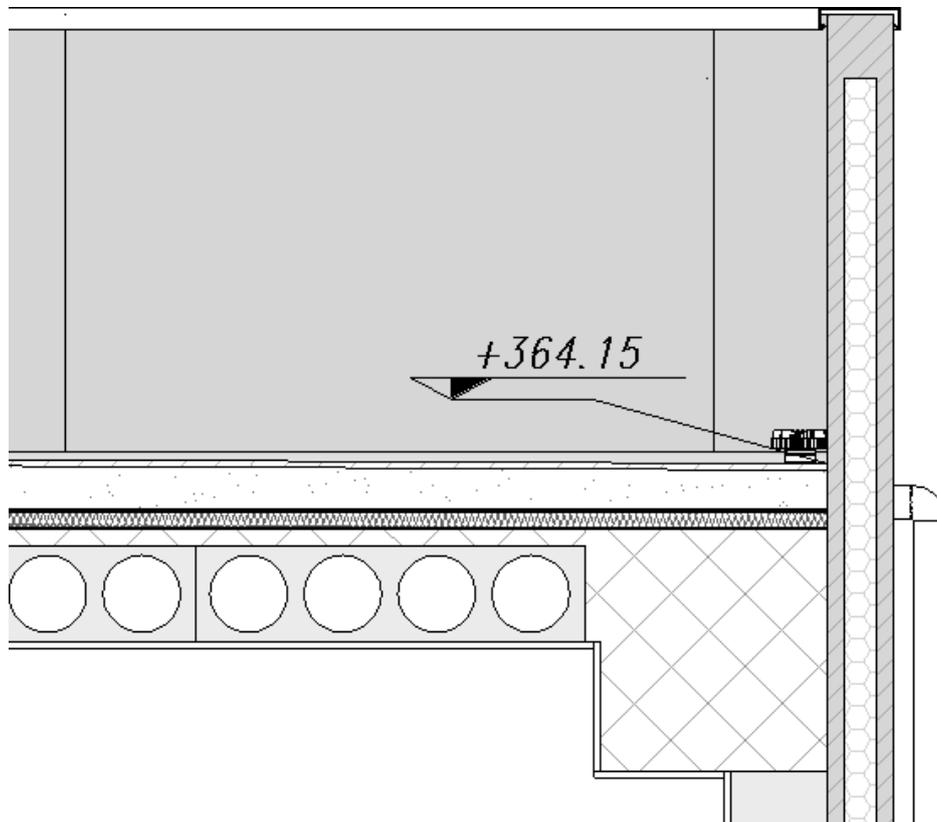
Particolare solaio alveolare e pannello esterno
